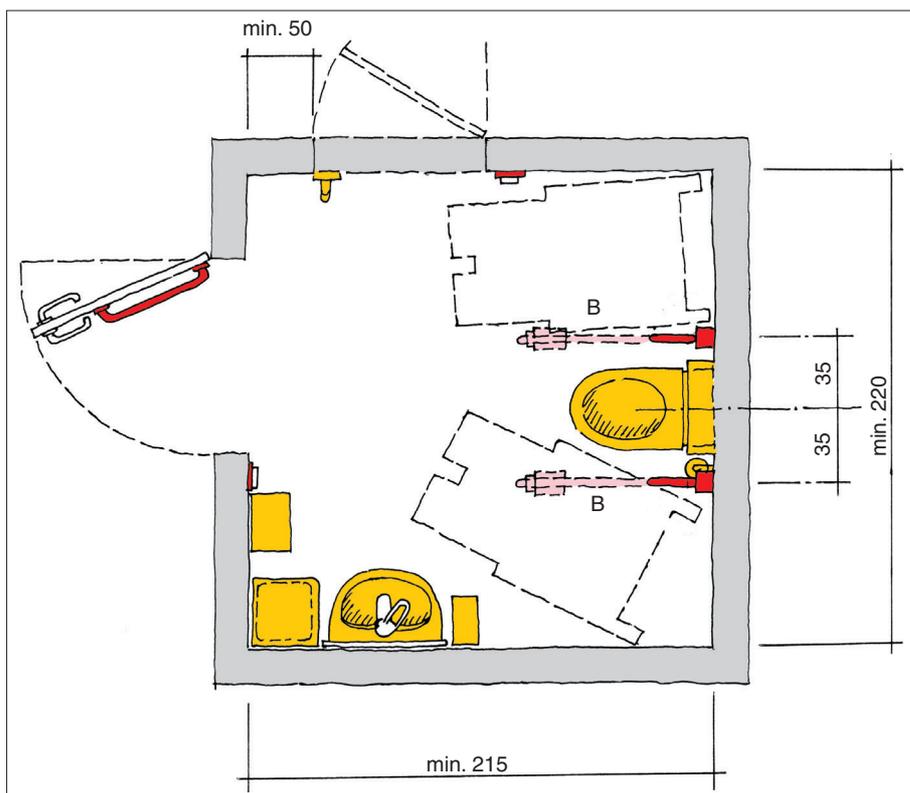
Grundrissvariante mit beidseitig anfahrbaren WC-Sitz
